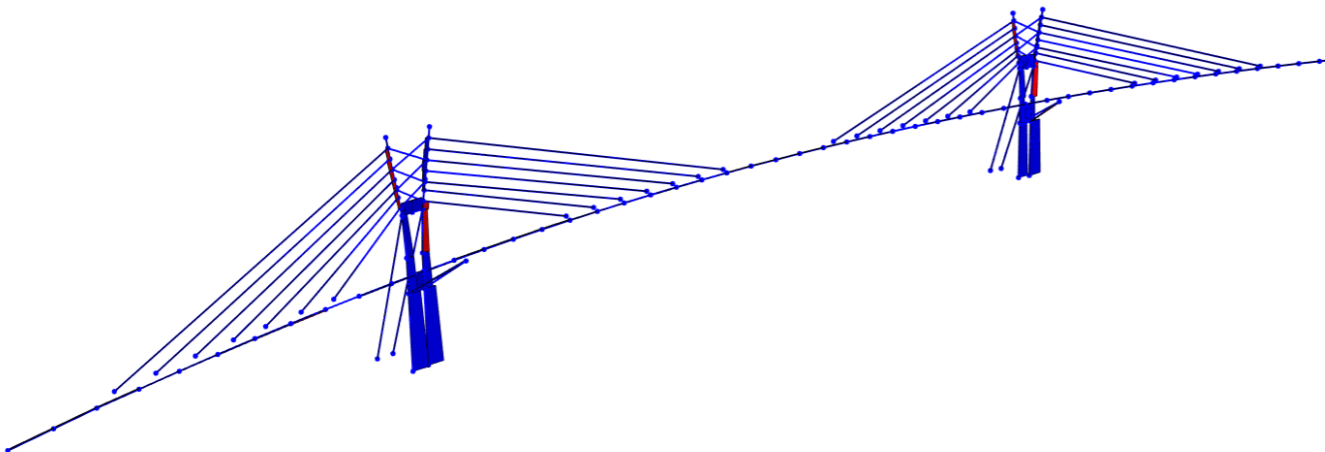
Diagrama de cortante de la estructura en el caso de carga Viento longitudinal "X" positivo. Fuente: Elaboración Propia (SAP2000)
